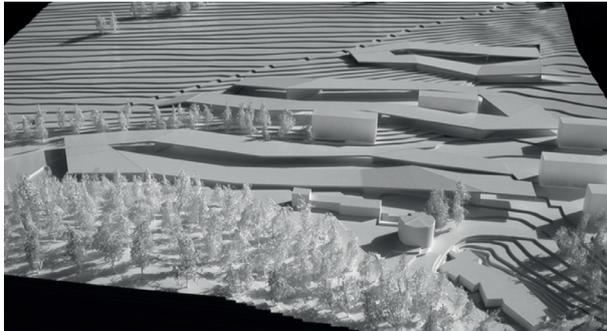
Städtebauliches und architektonisches Grundkonzept (Arch. Wiesflecker)
